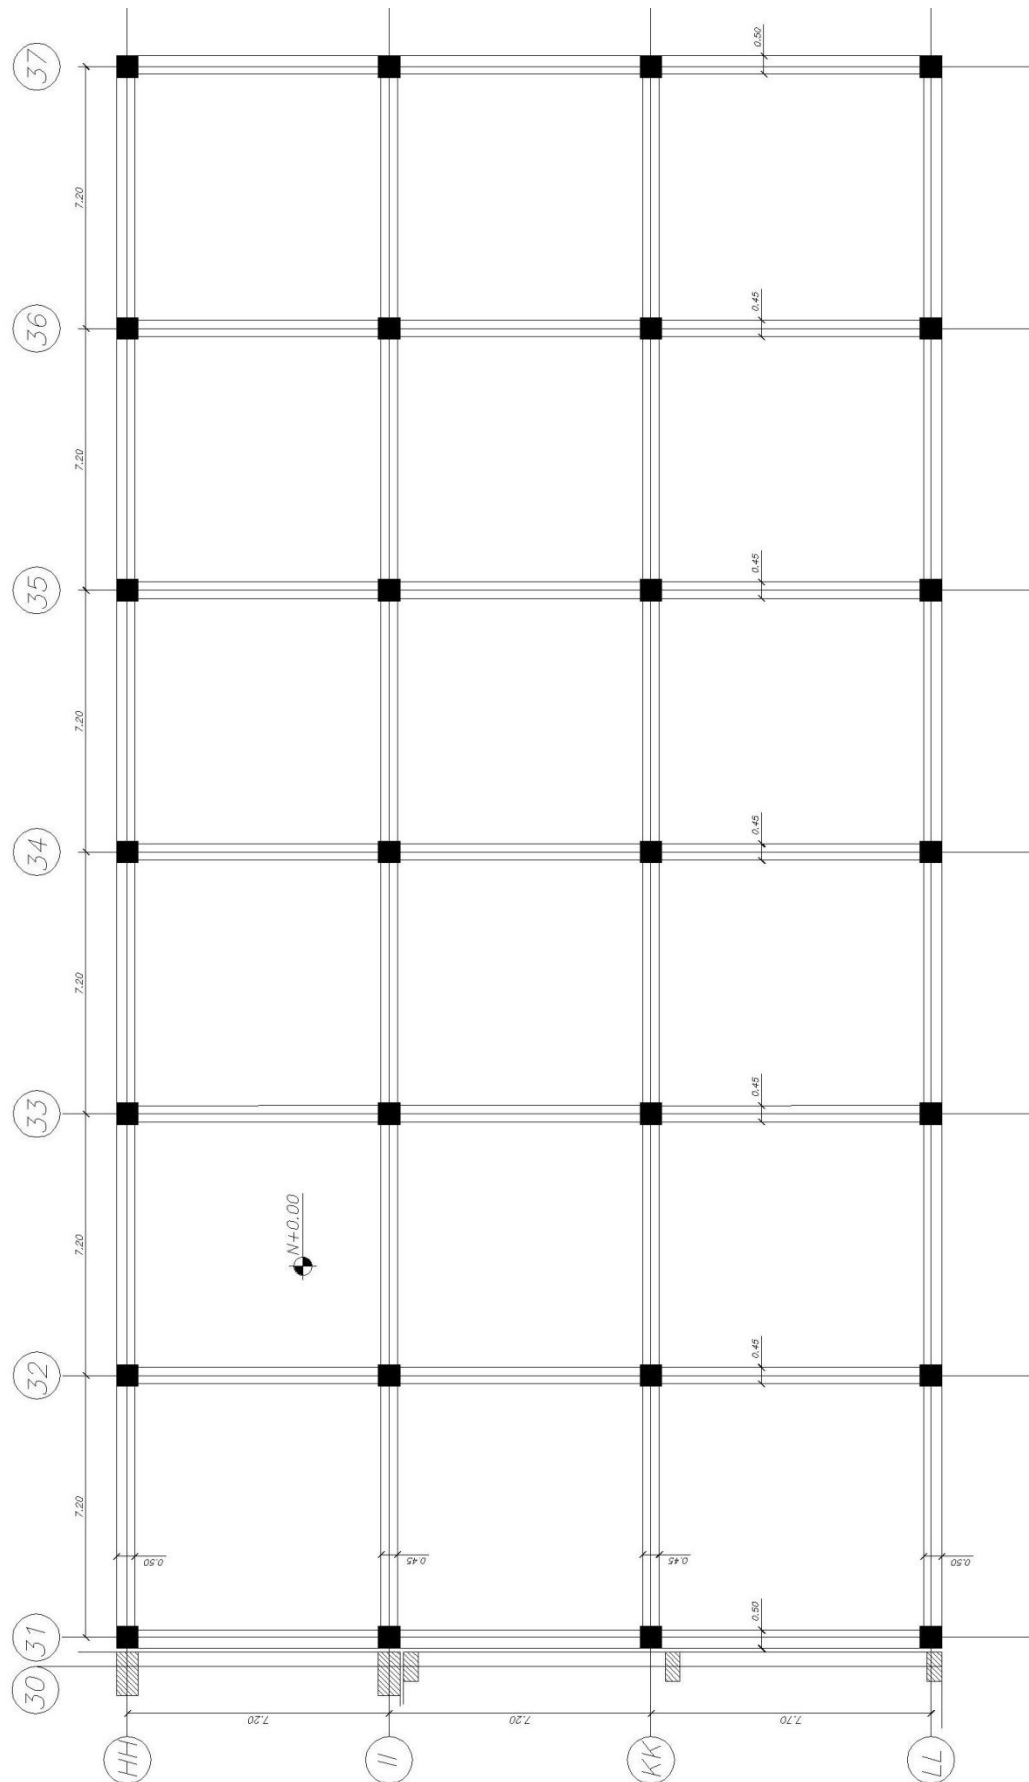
PLANTA ESTRUCTURAL NIVEL: +0,00 m C. QUIRURGICO
